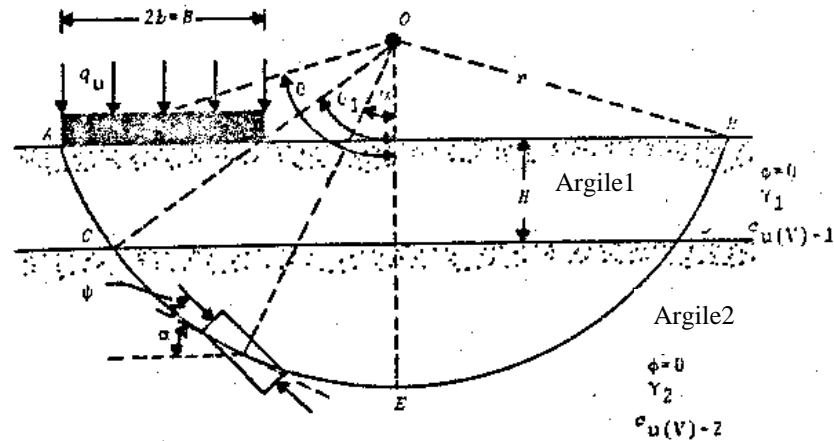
Fondation continue sur un sol bicouches argileux anisotrope ($\phi = 0$) (Reddy et Srinivasan, 1967).
